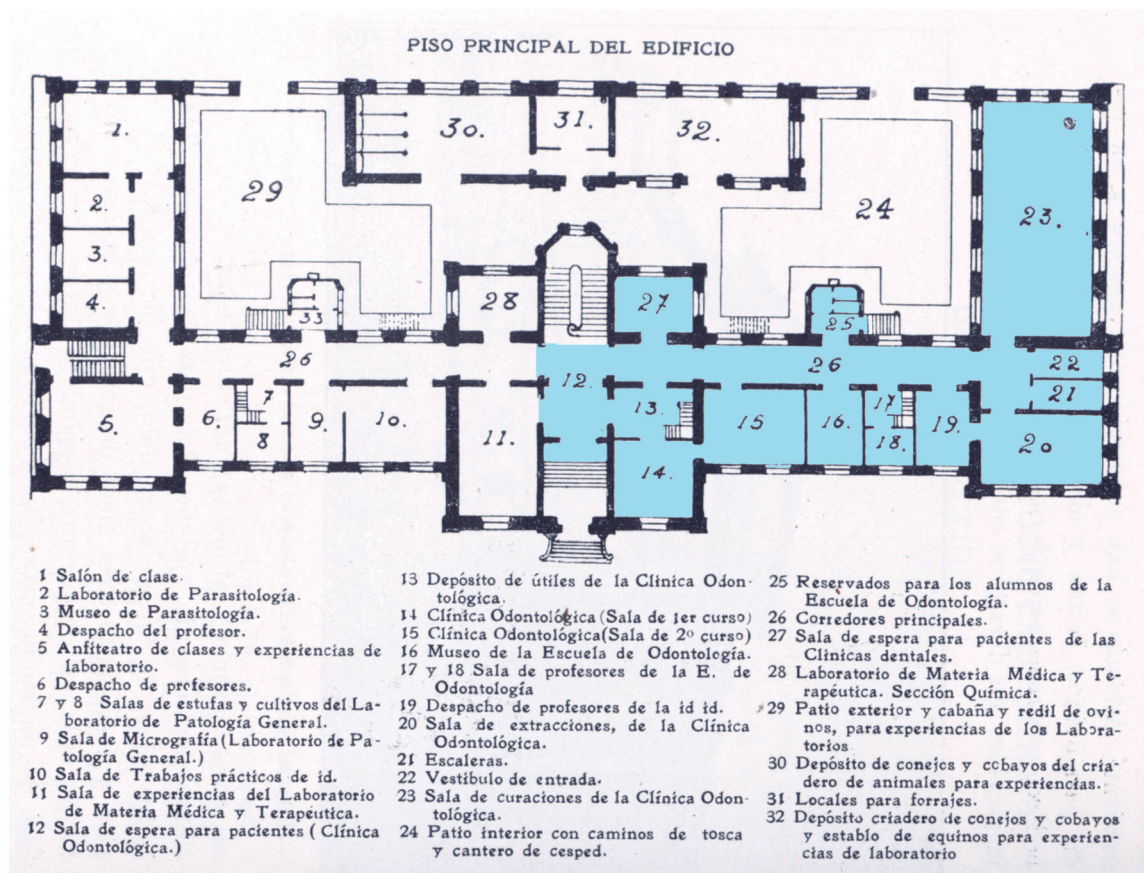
Plano de la Planta baja. En color celeste las instalaciones pertenecientes a la Sección Odontología
